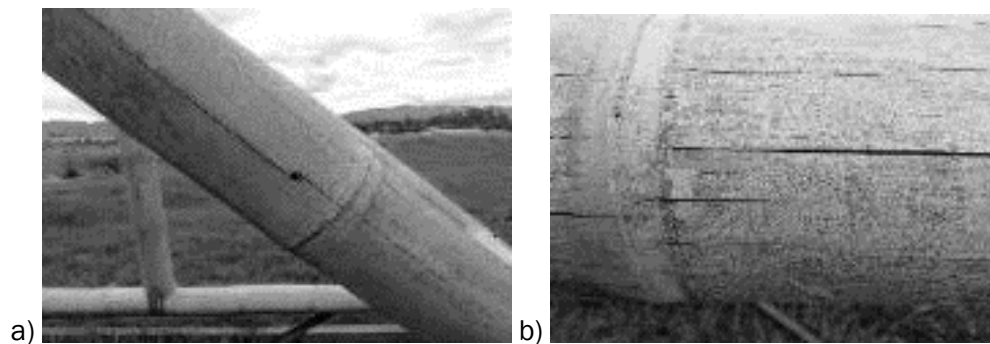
a) Grieta provocada por la perforación fisura en el elemento horizontal; b) fisuras superficiales de más de 0,5 mm.
